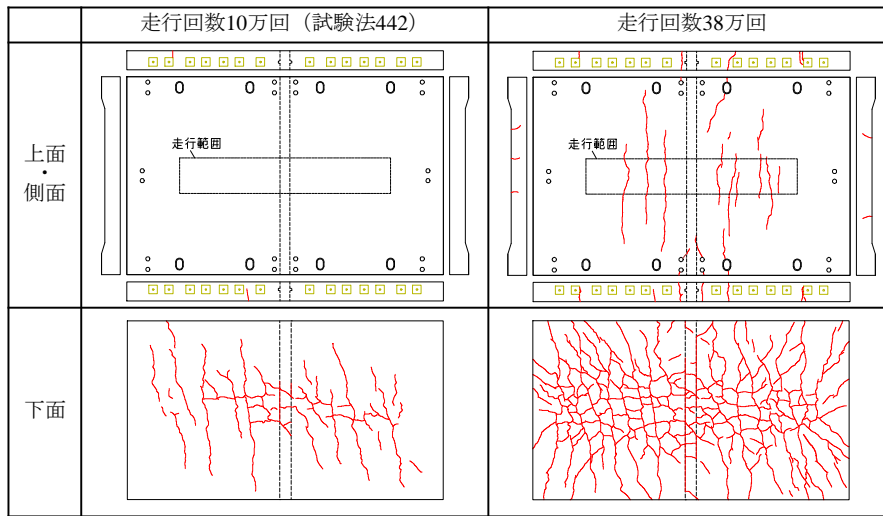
走行回数 10 万回および 38 万回時点のひび割れ図
